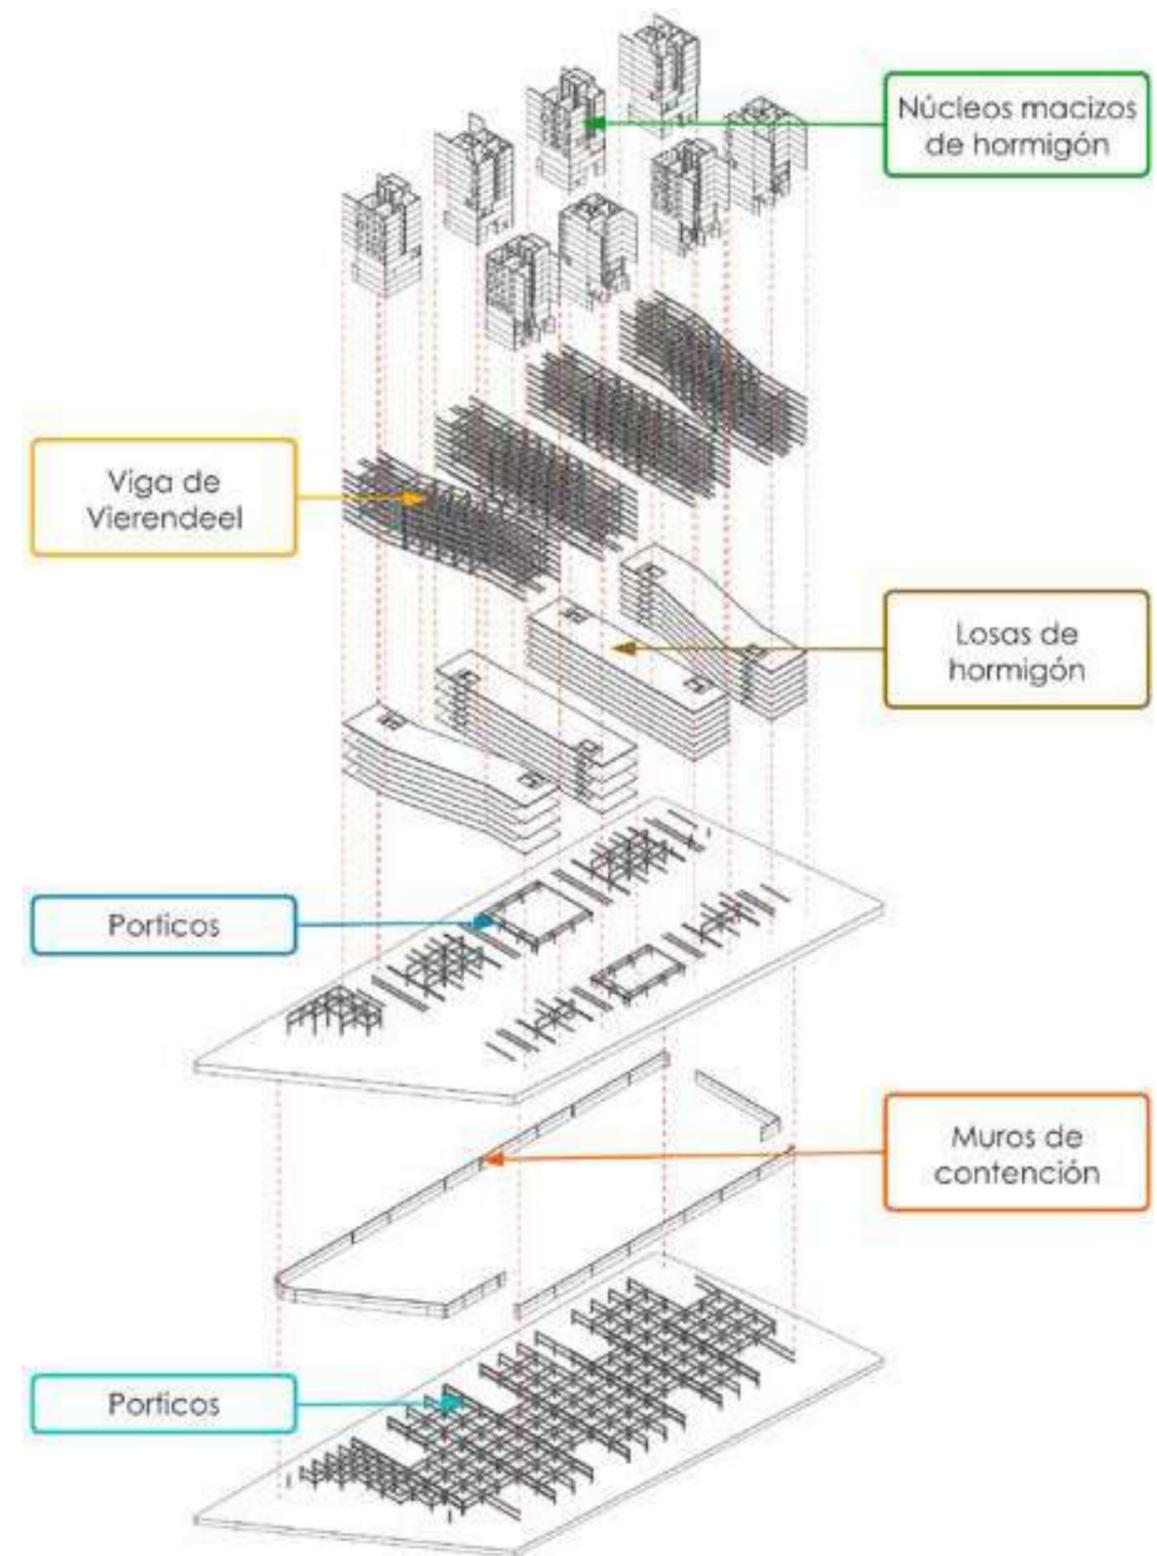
propuesta estructural. Fuente: elaboración propia.
